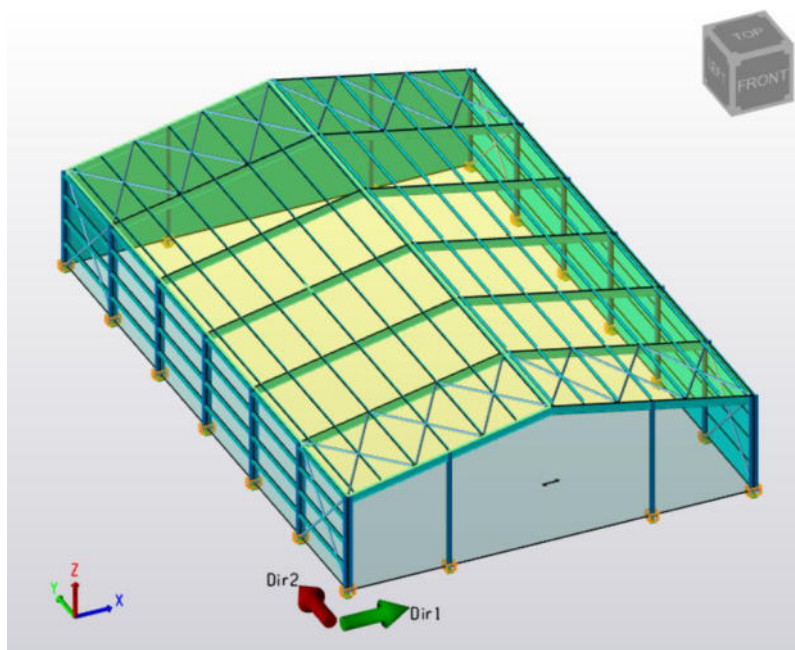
Estrutura exemplo – pavilhão industrial metálico
